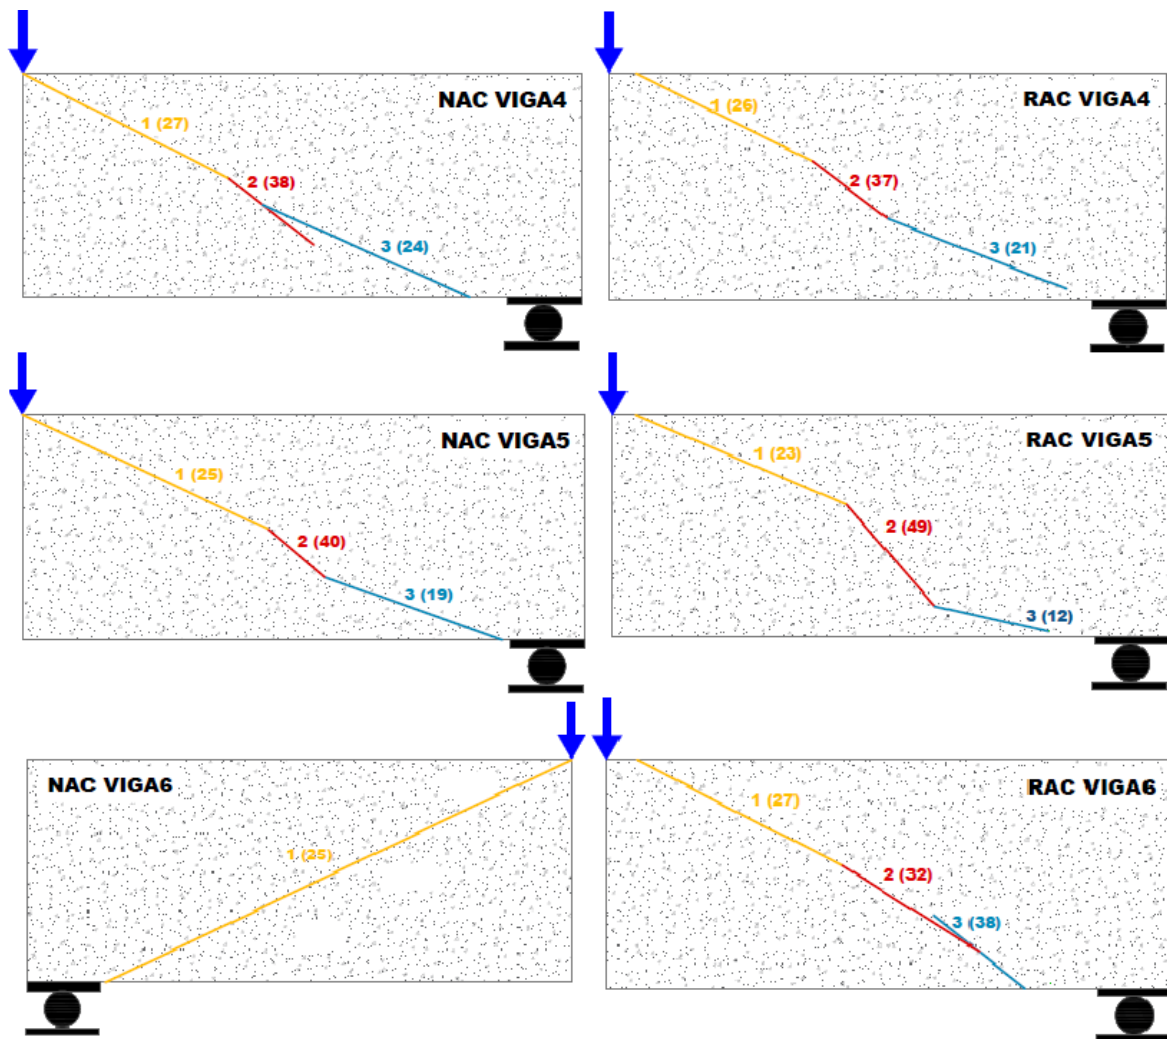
Formato simplificado da fissura diagonal crítica das vigas com estribos.
